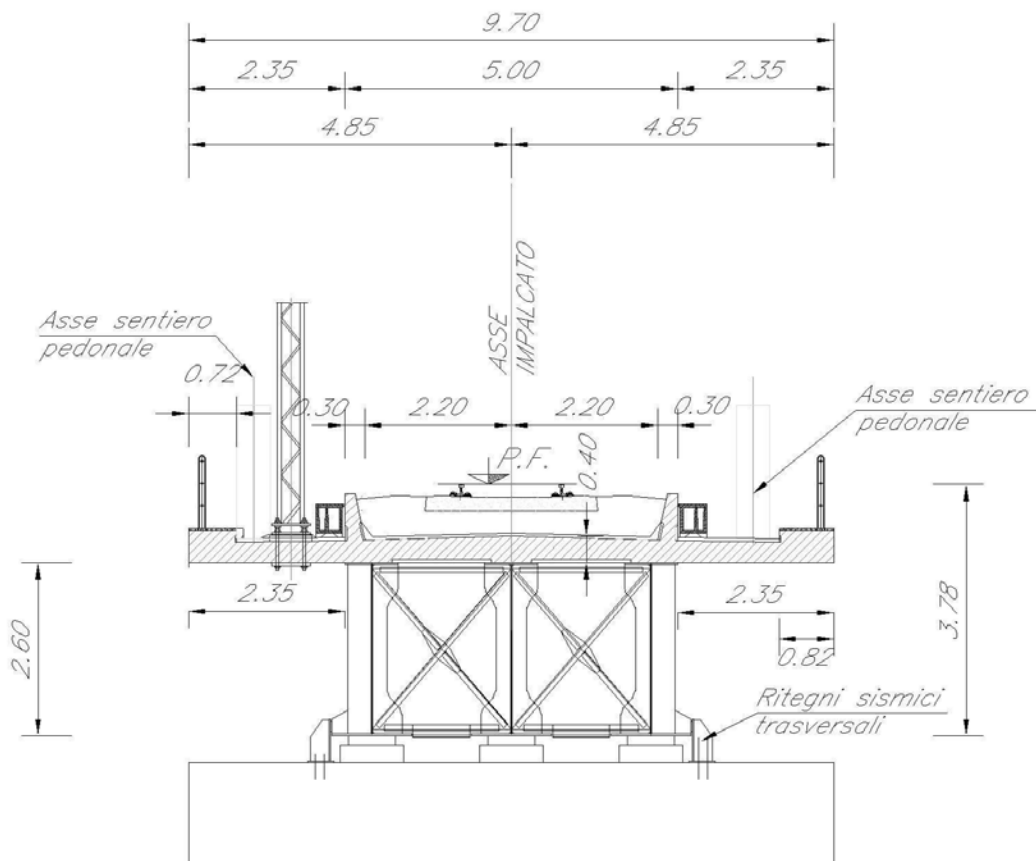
Sezione trasversale impalcato a struttura mista acciaio/cls.
